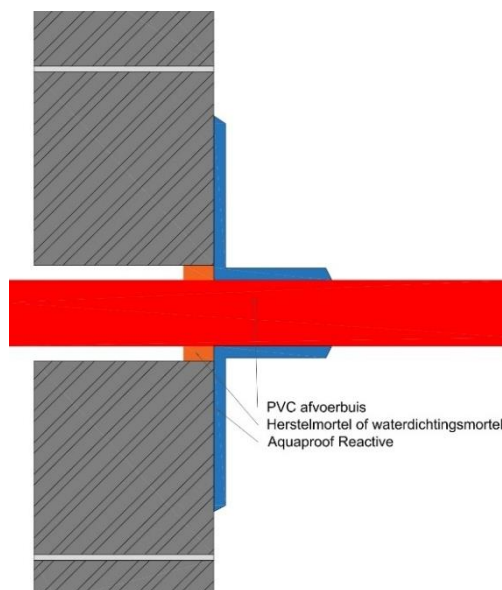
Waterdichting ter hoogte van doorvoeren: doorheen gemetste wand in betonstenen
